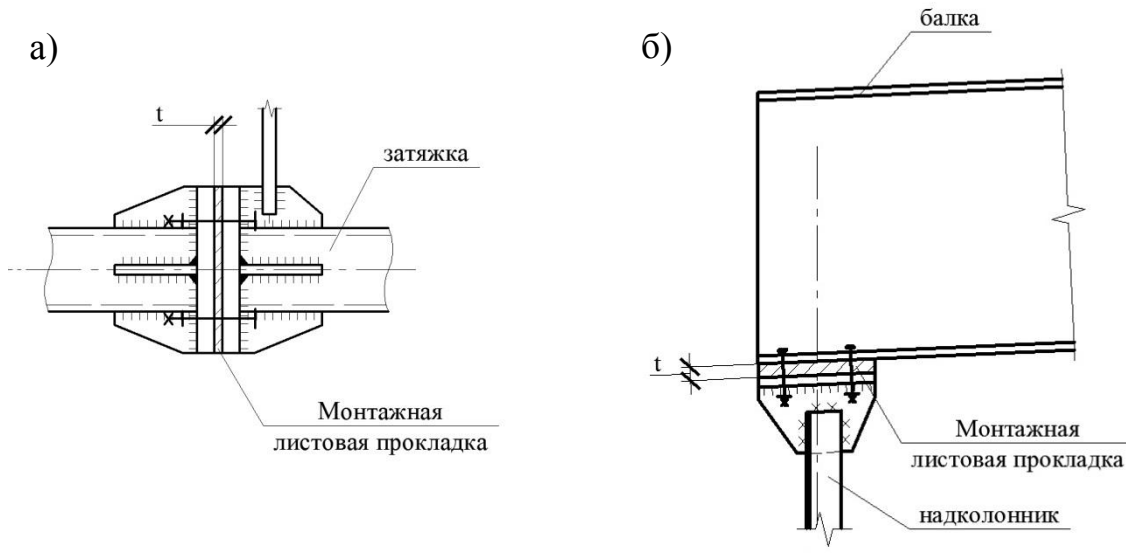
Создание предварительного напряжения в конструкции смыканием зазоров в монтажных стыках: а) затяжки; б) надколонника с балкой
